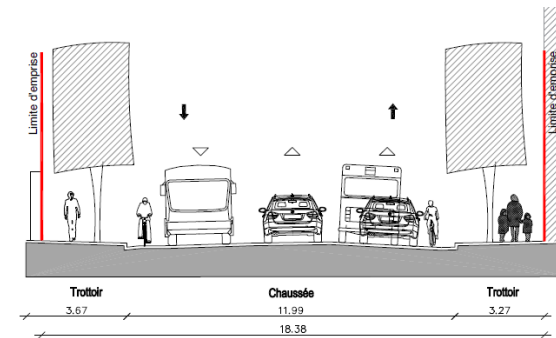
Coupe type en section courante sur le boulevard Berteaux
